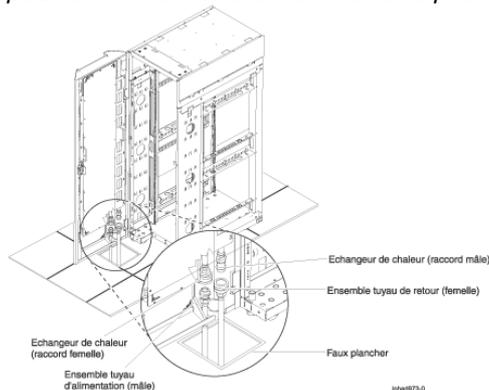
Exemple 1 - Gestion des tuyaux dans un environnement avec faux plancher - Dimensions et position de l'ouverture dans la dalle pour des armoires 610 mm (24 pouces) à rails EIA
